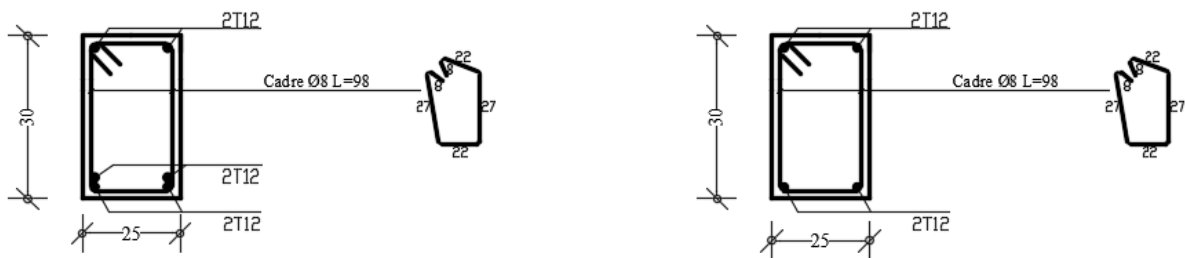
Dessin de ferrailage de la poutre palière
